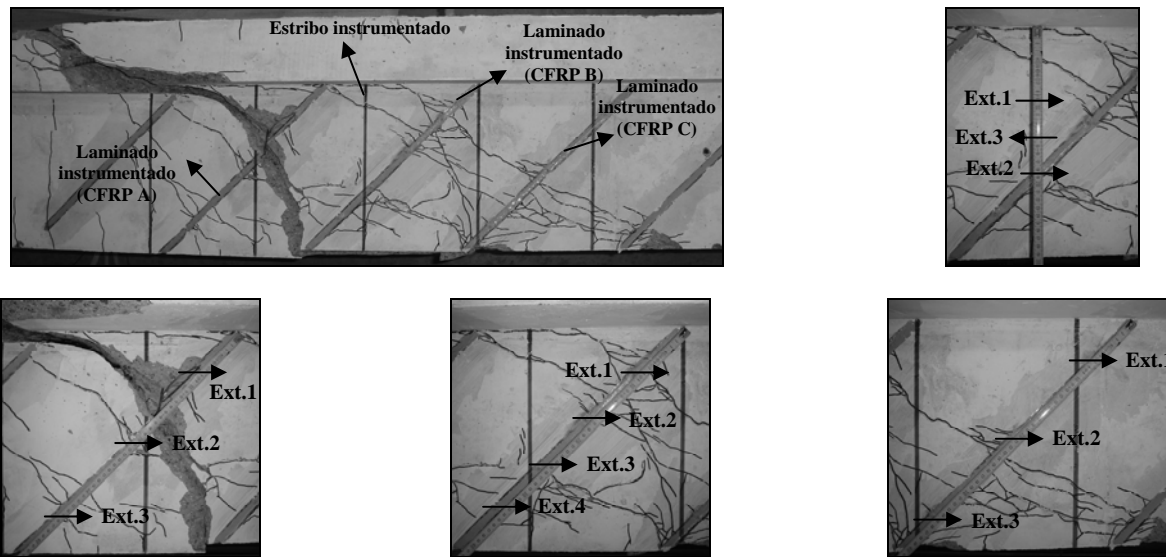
Localização dos extensómetros no laminado e estribo instrumentados da viga 5S-5LI45-D.
